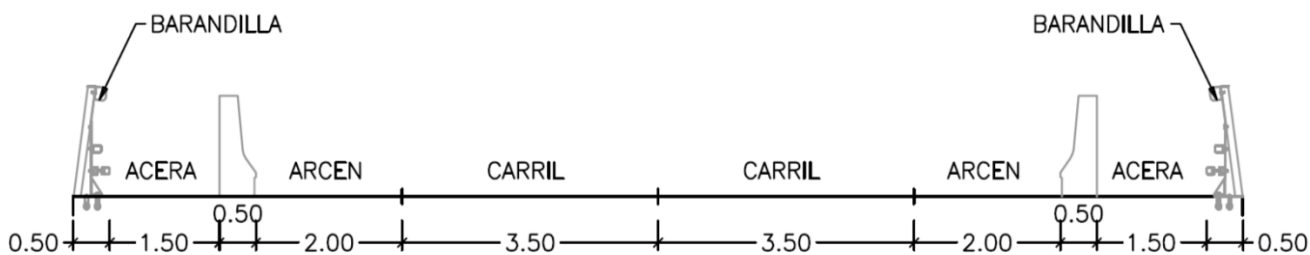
Sección transversal tipo de la estructura sobre el río Paraná
